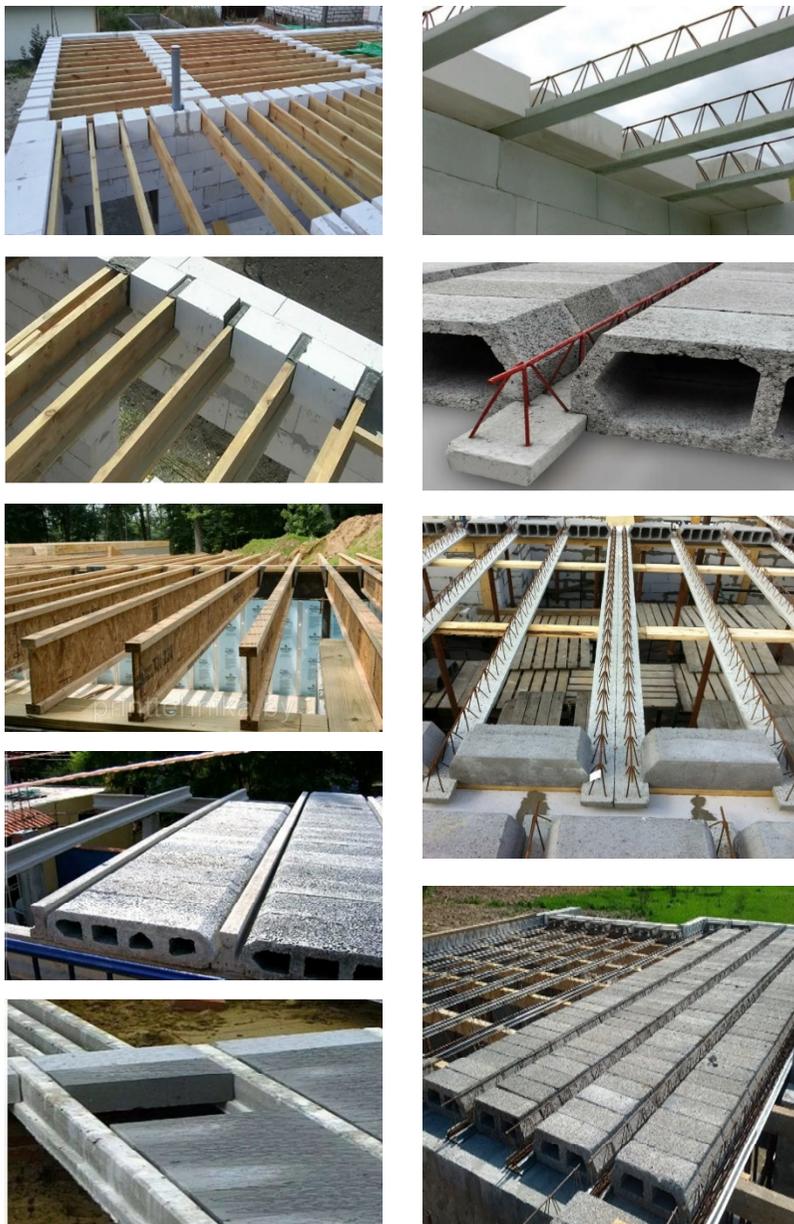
Примеры конструкций перекрытий по деревянным и железобетонным балкам
